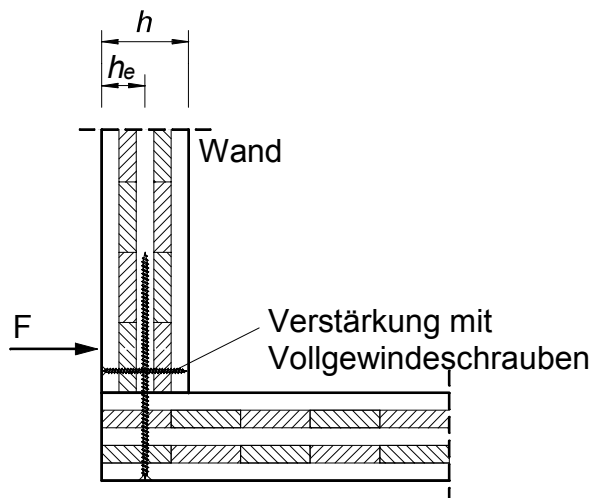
Verstärkung einer Brettsperrholzwand mit Vollgewinde Schrauben
